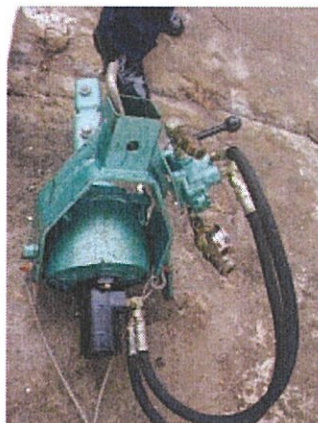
Motor hidráulico o rotor sumergible.
